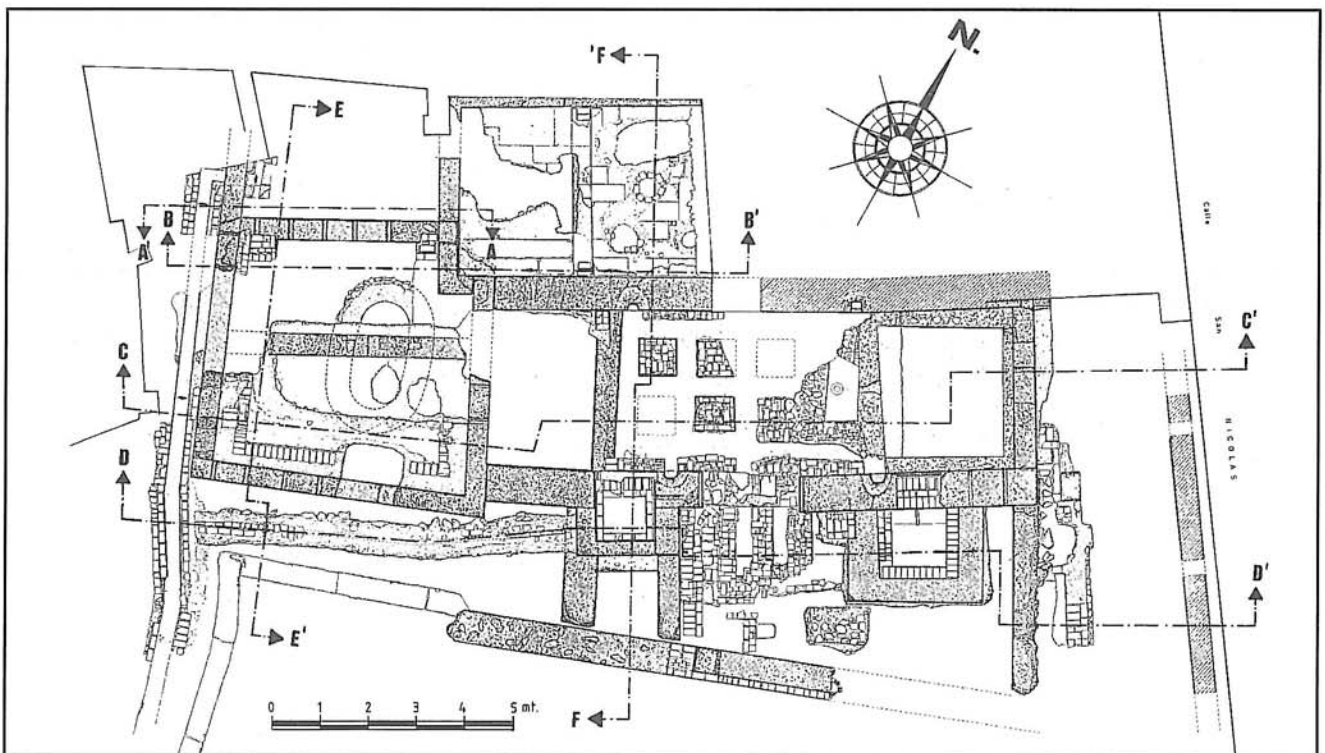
Planta del Baño de San Nicolás con indicación de los cortes de las secciones.
